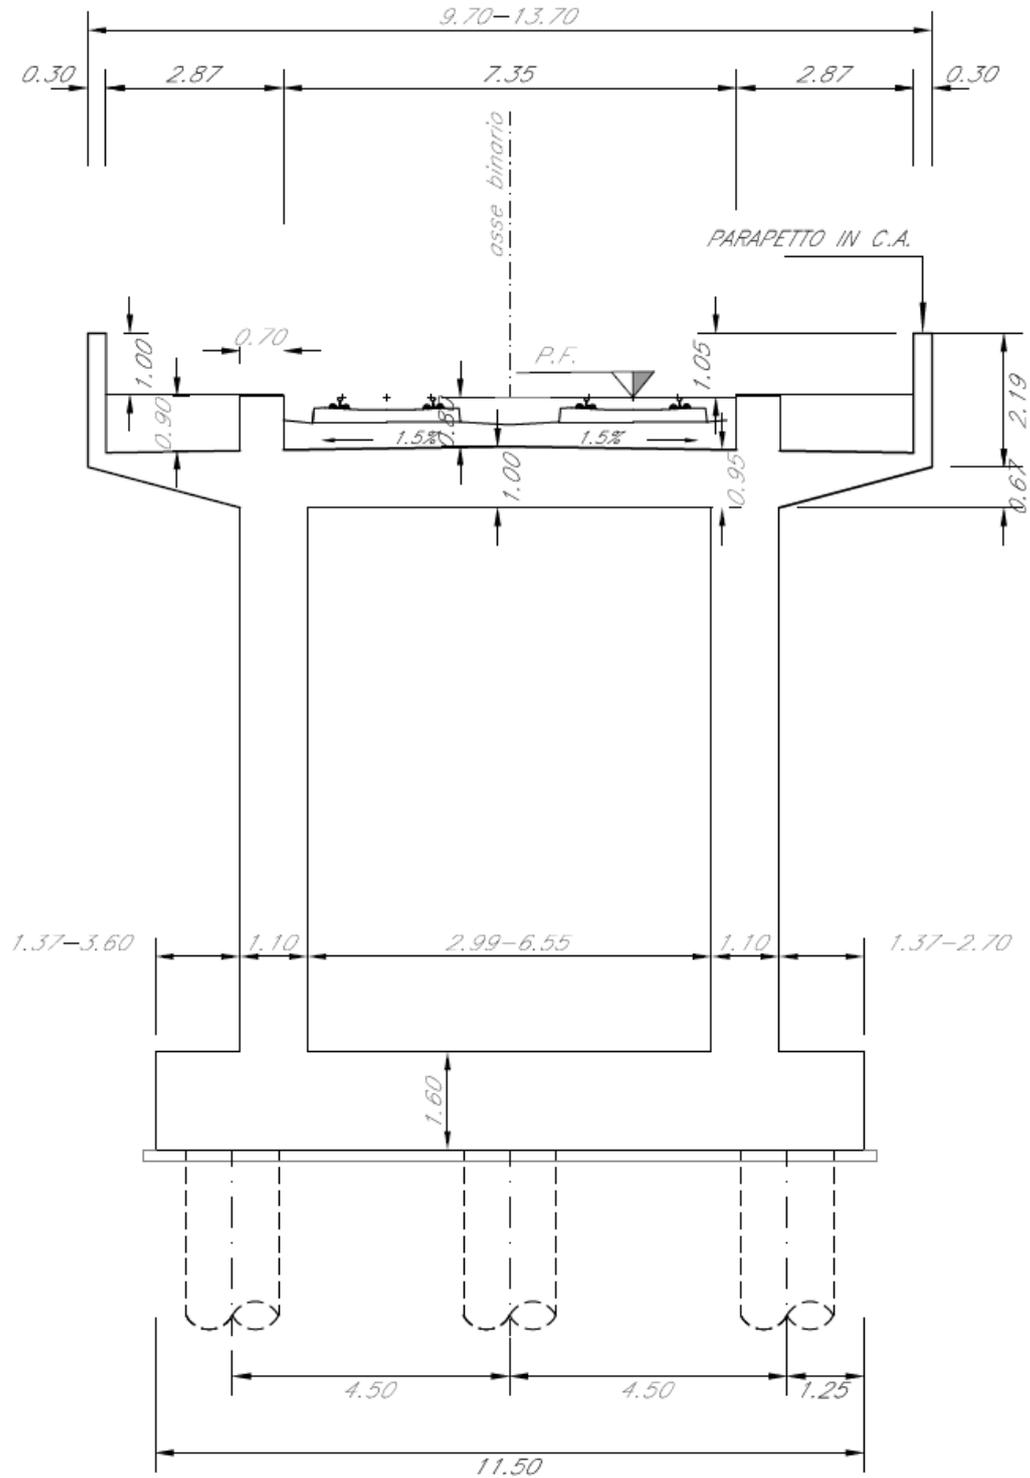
Sottovia scatolare SL05- Sezione trasversale
